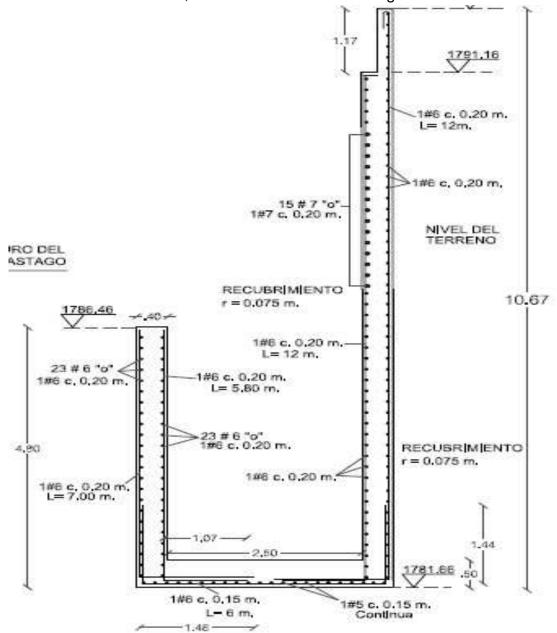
ACERO DE REFUERZO VERTICAL PARA CAJON ZONA VASTAGO ESTRIBO No. 3
